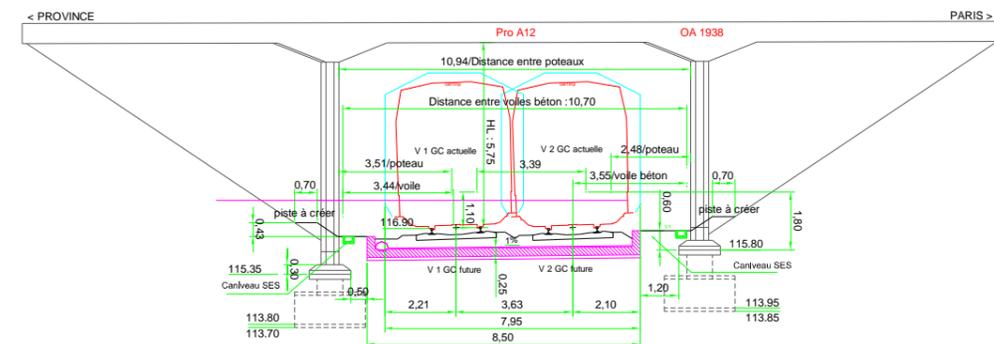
Coupe du pont Route de l'A12 (Source : AVP- juillet 2015)
